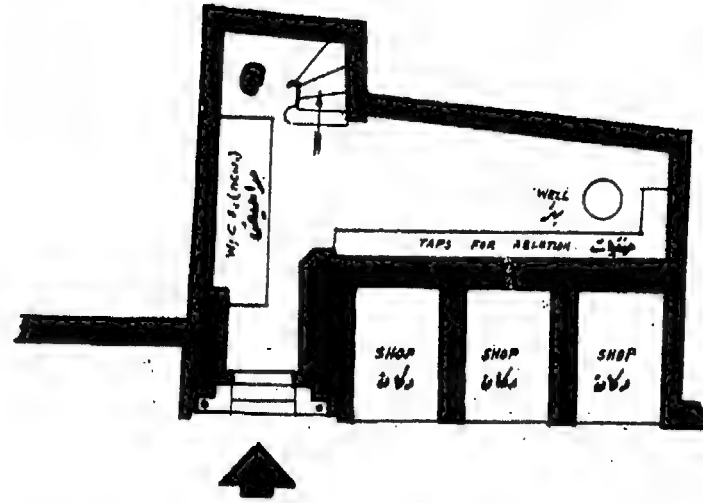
مسقط أفقى للدور الأول بمسجد الشواذلية بالموسكى.
